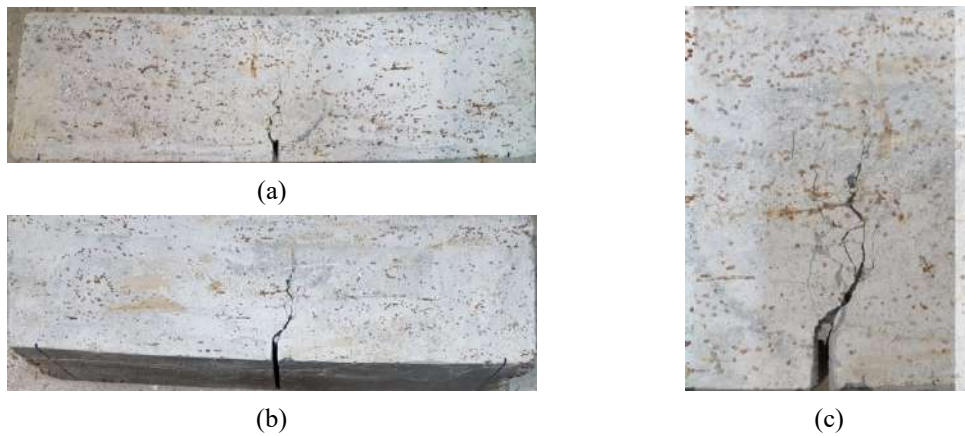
Assimetria do padrão de fissura em corpos de prova prismáticos com dimensões 12x12 x 45 cm³: (a) frente do corpo de prova, (b) verso do corpo de prova, e (c) sobreposição das fissuras.
